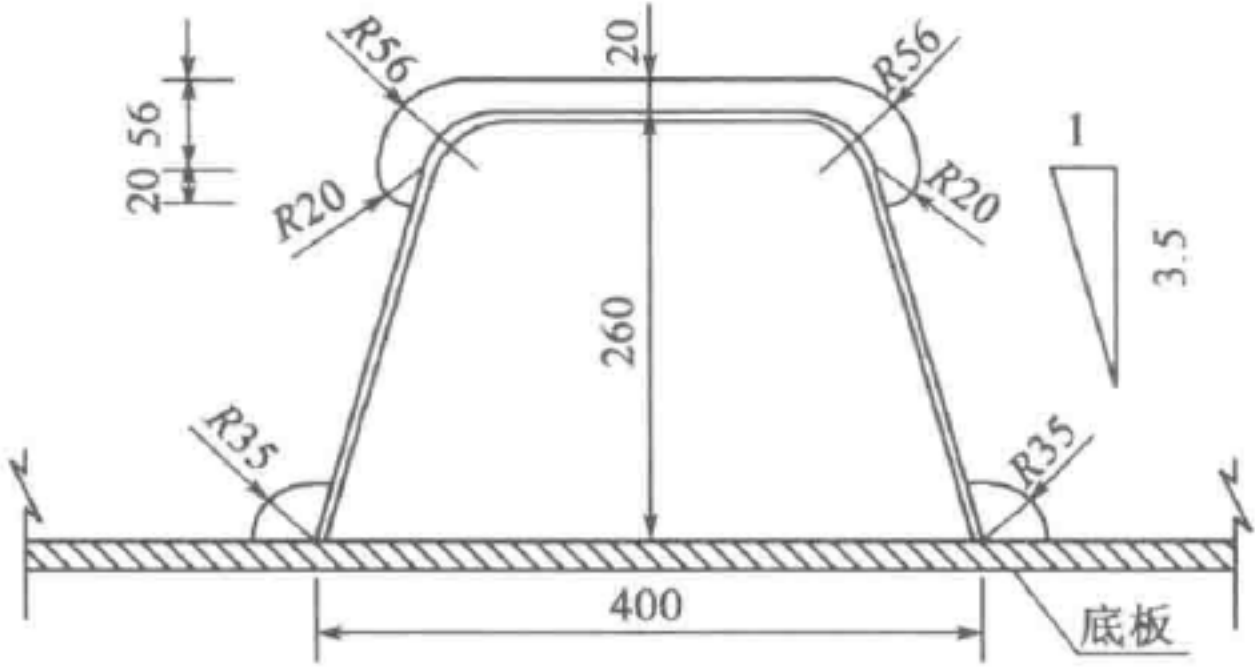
底板 U 肋及通过孔构造(尺寸单位:mm)
